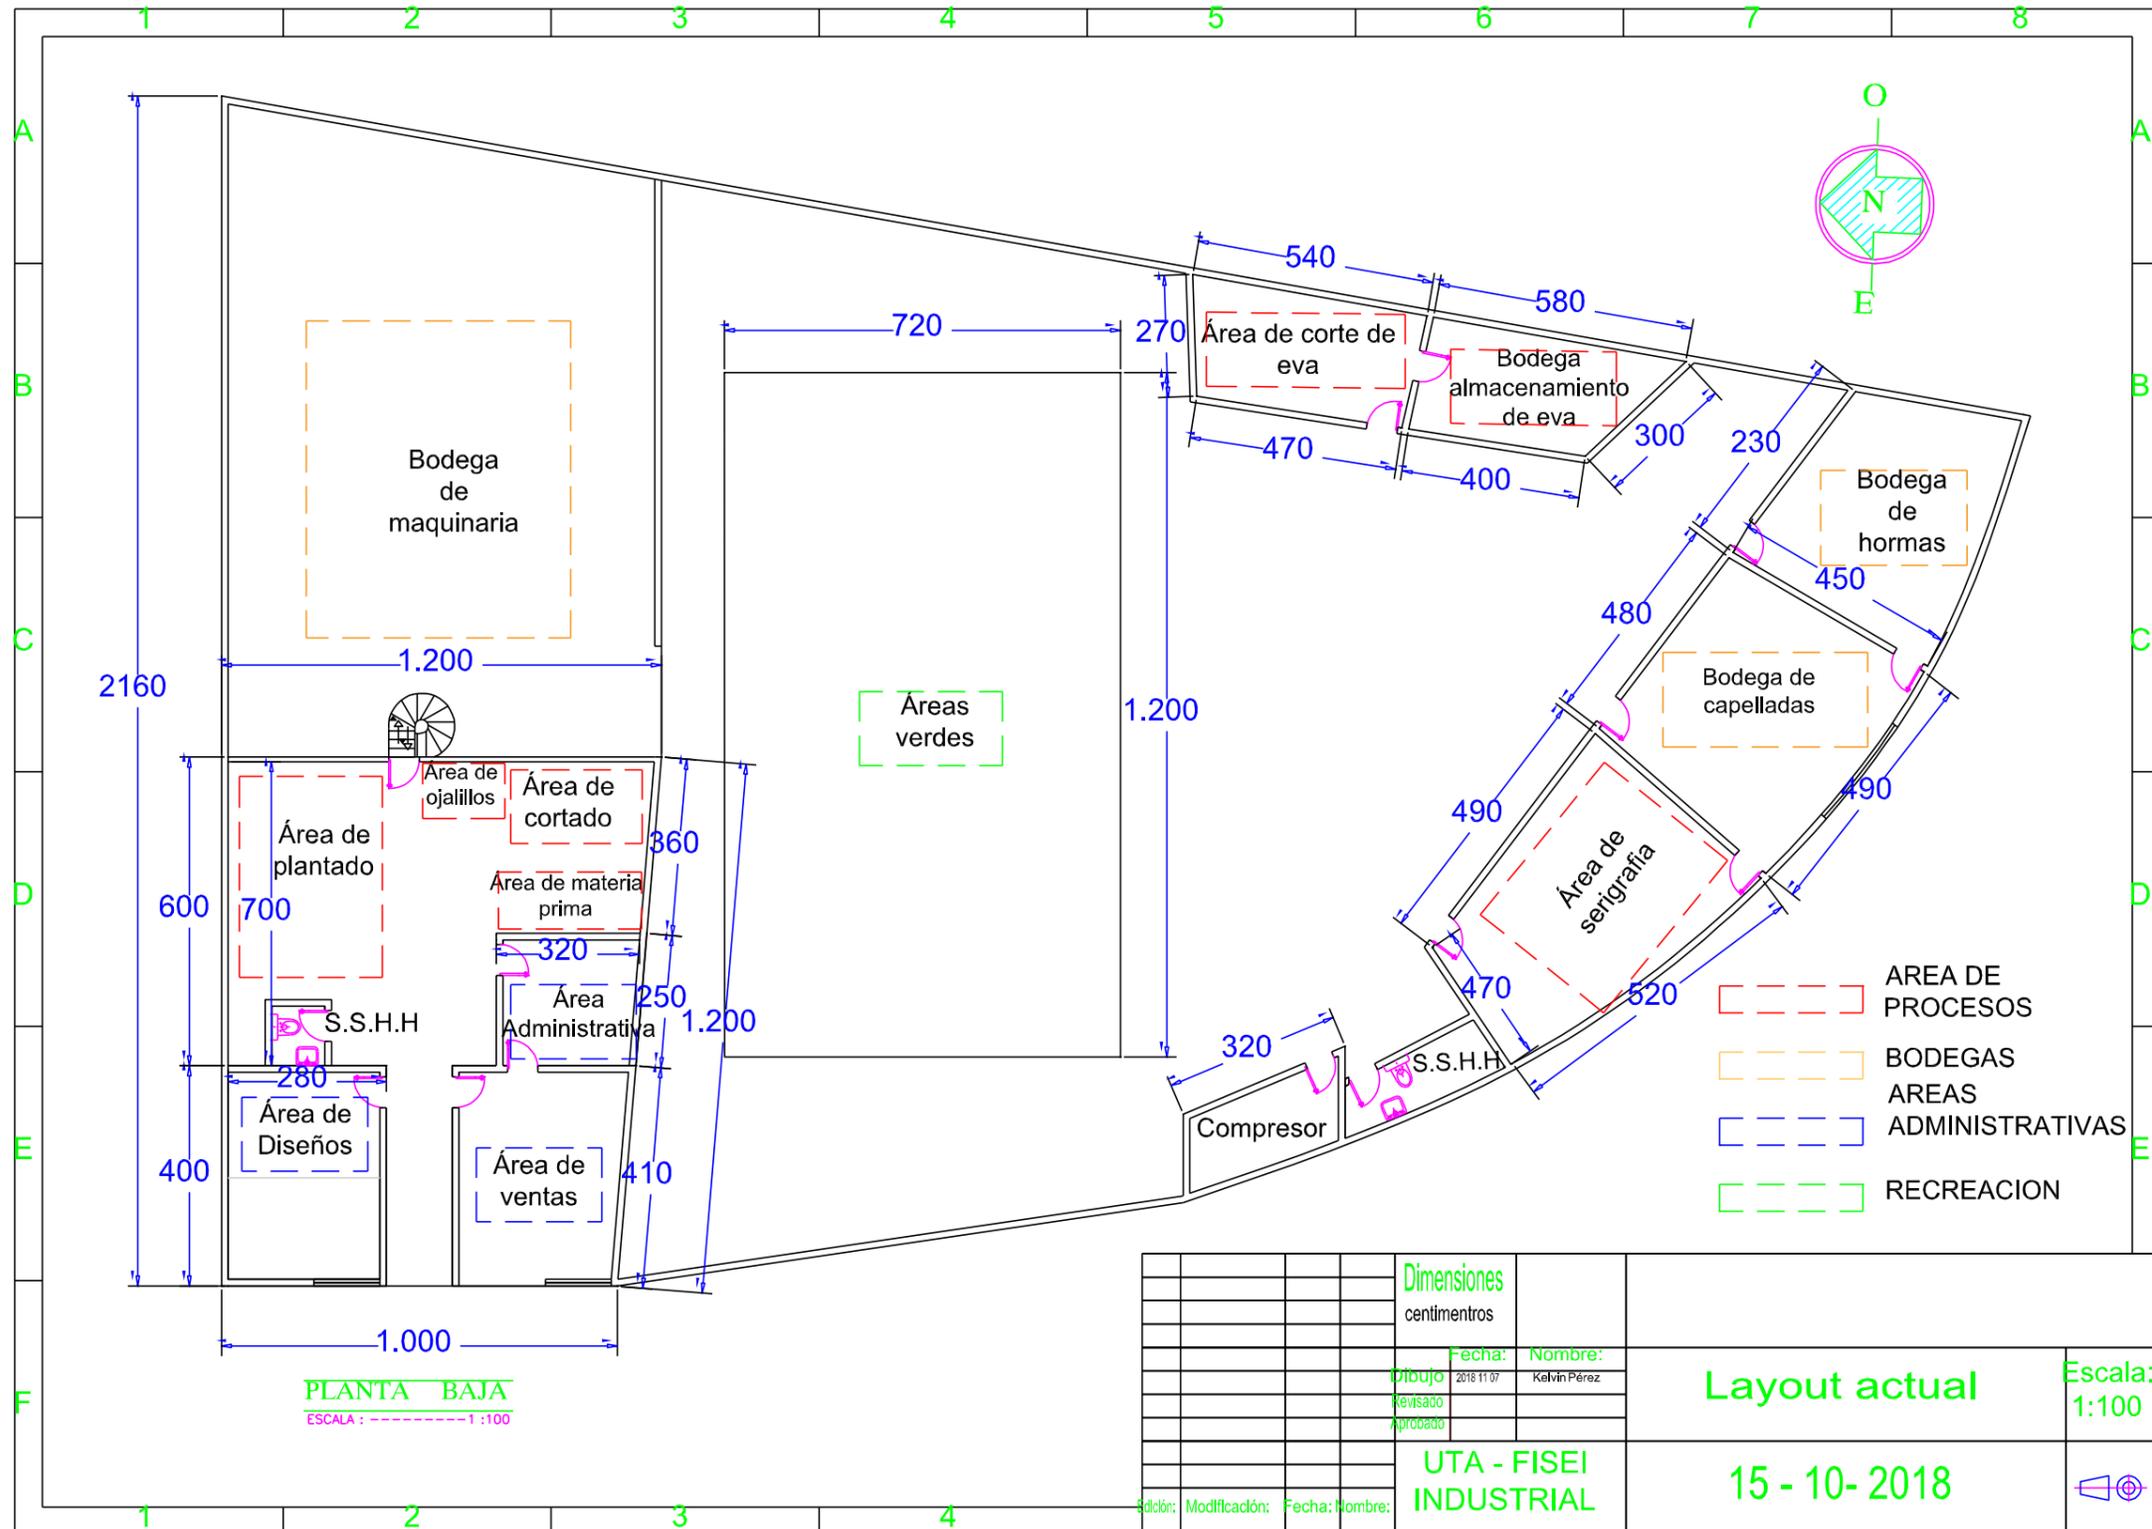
Layout actual de la empresa planta baja, desde AutoCAD 2015
